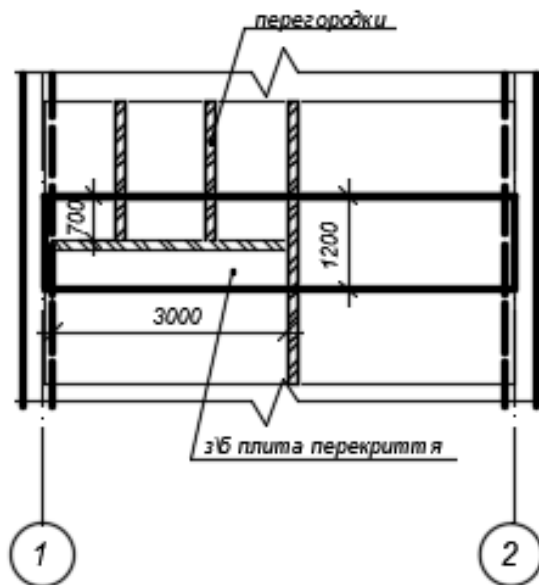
Схема розташування перегородок над частиною плити перекриття.
